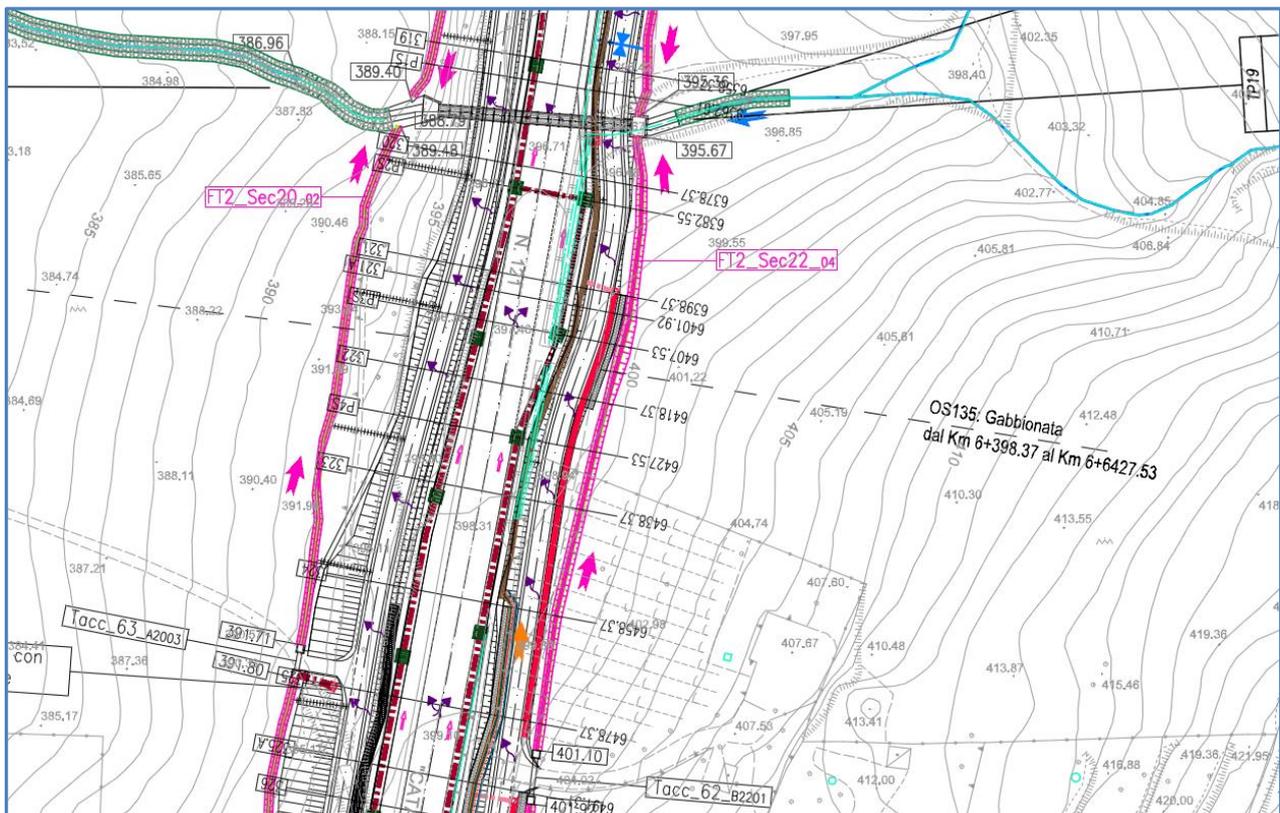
Stralcio della planimetria idraulica di progetto.
